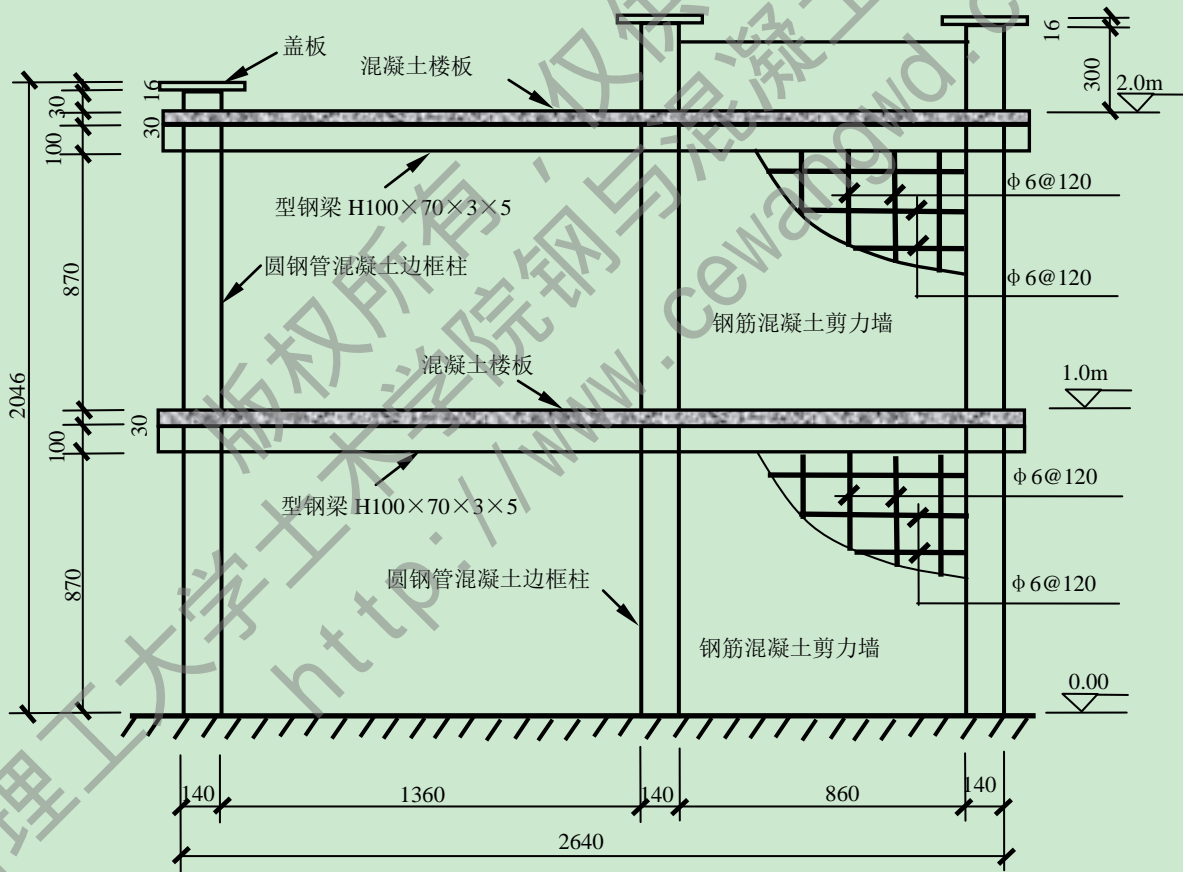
钢管混凝土框架-RC 组合剪力墙试件尺寸及配筋详图
